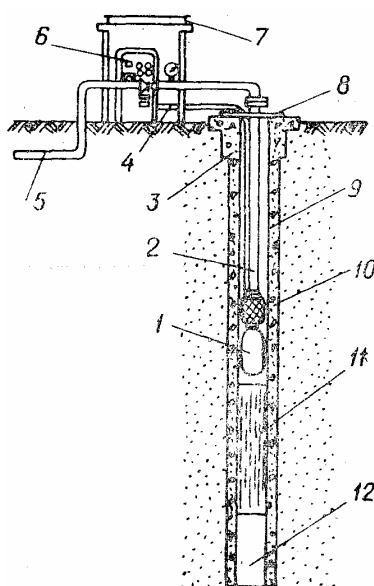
Схема скважинной насосной установки вертикального дренажа:
